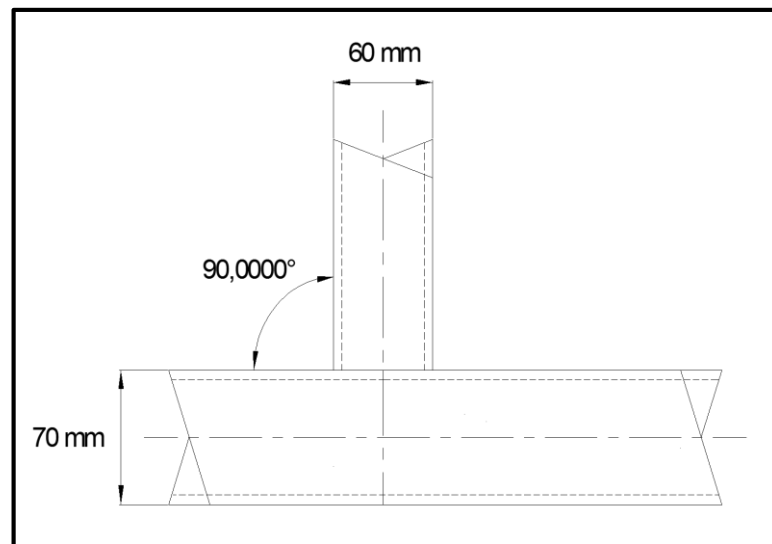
Detalle de las juntas de la armadura, conexión en T-
